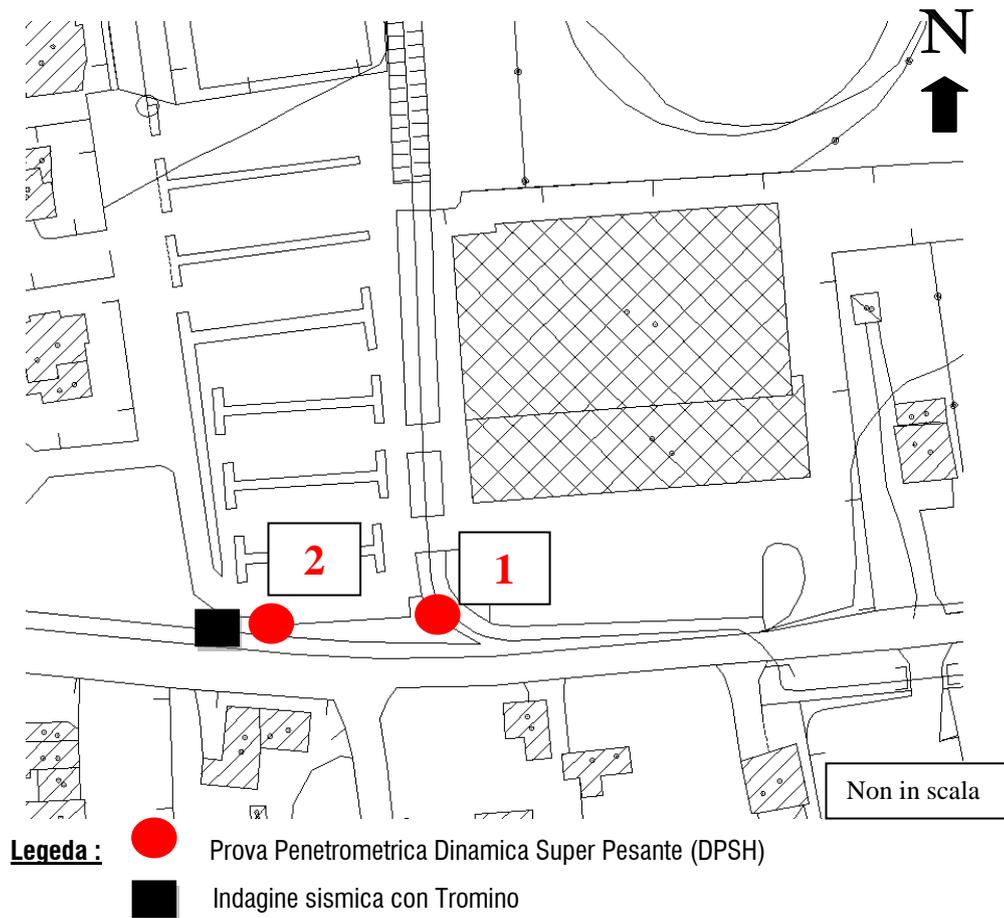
Planimetria non in scala con ubicazione prove eseguite
